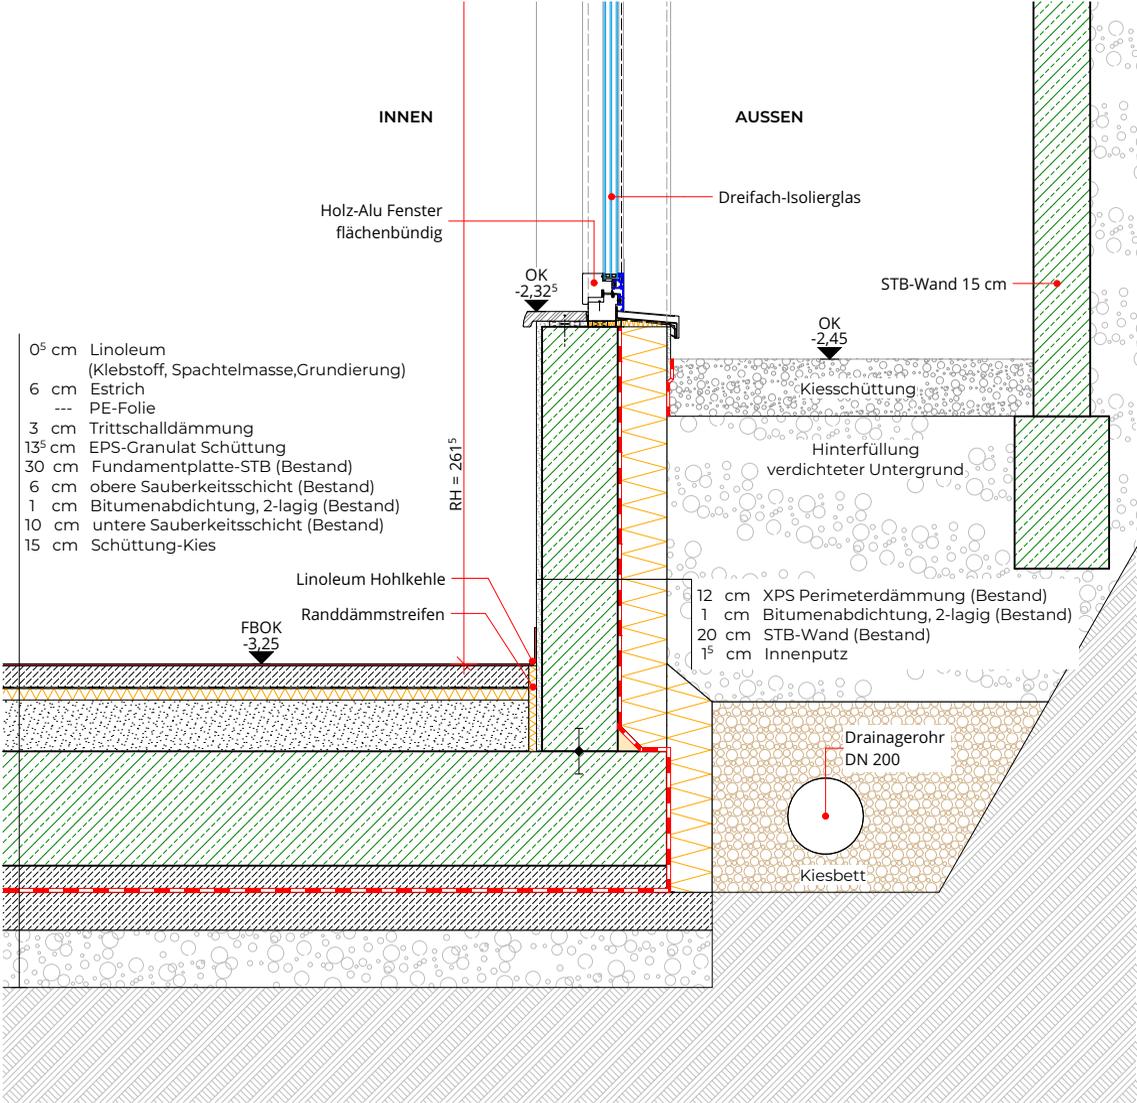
D01_Fundamentplatte - Kellerwand mit Fensteranschluss
